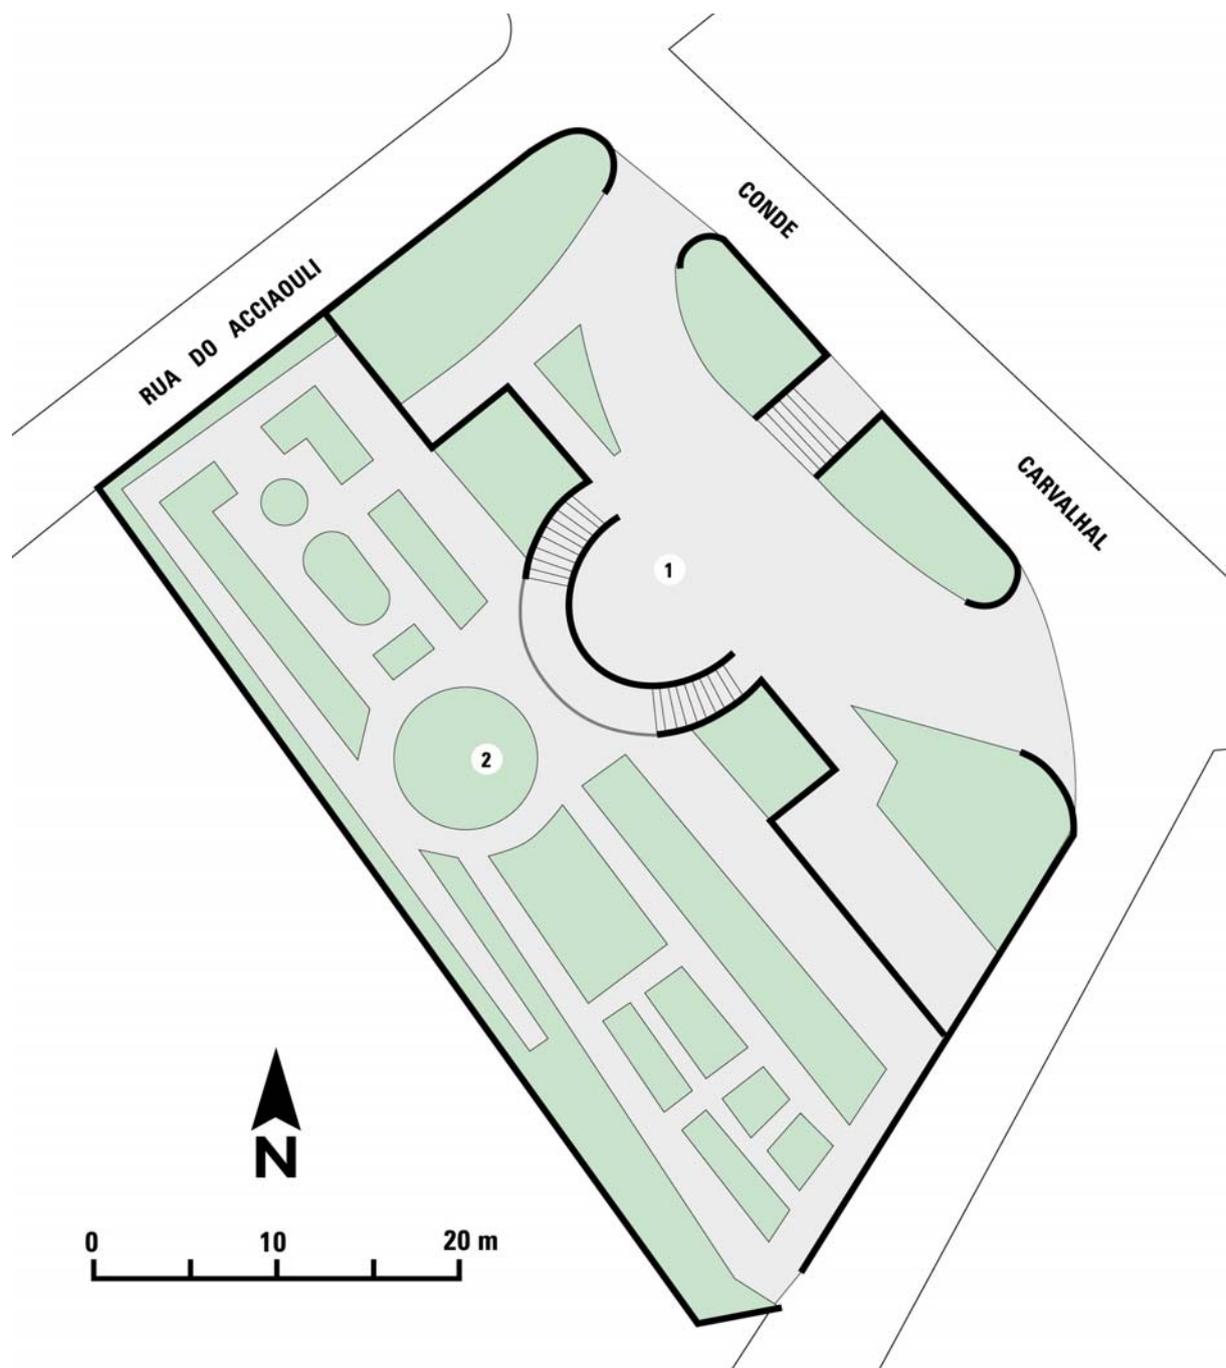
Planta do Jardim do Miradouro Vila Guida
